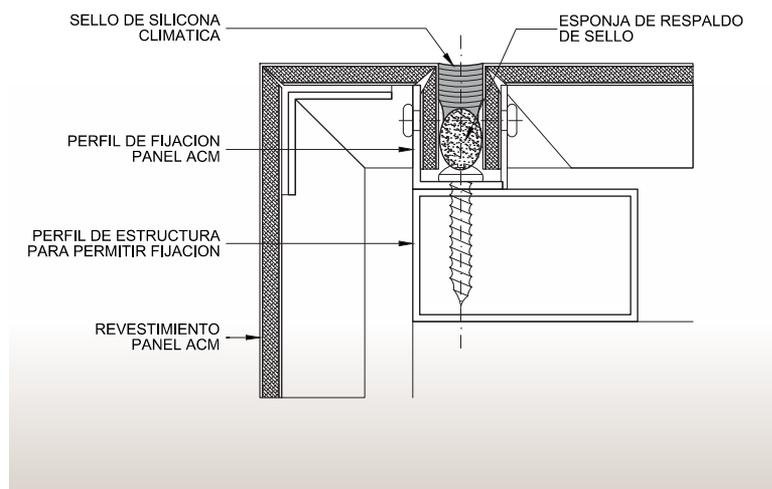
Detalle Horizontal de sellado de panel ACM (Con perfil ángulo de refuerzo en la esquina).
